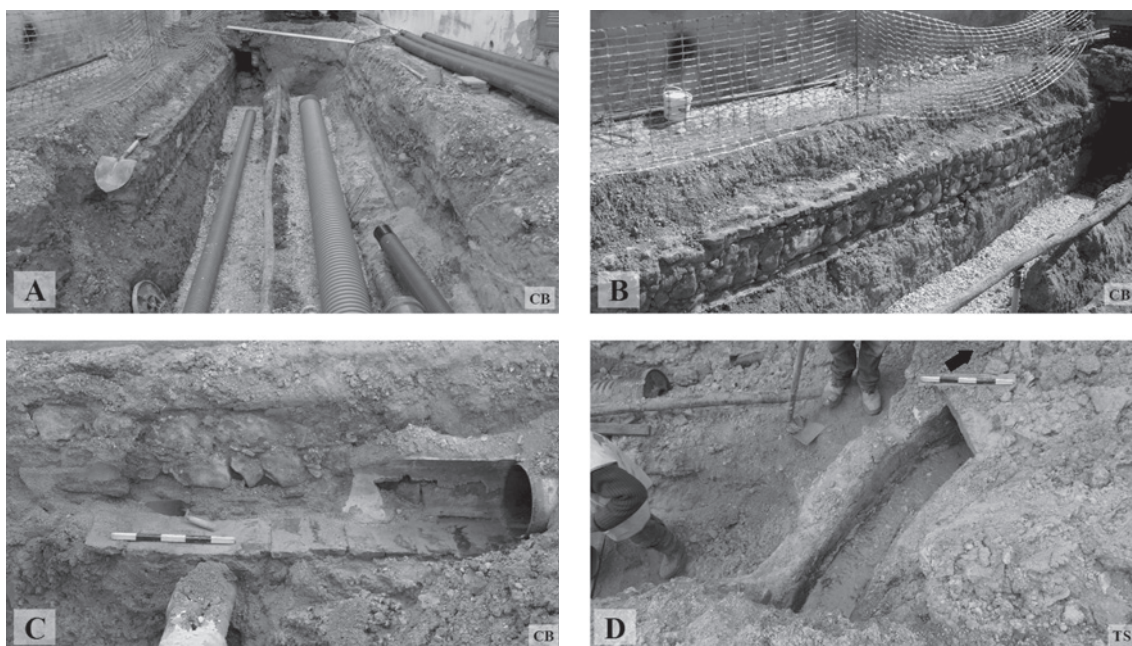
A – Vista geral dos trabalhos na Rua Braamcamp Freire; B – Vista geral da parede Este da conduta de saneamento que foi preservada *in situ*; C – Pormenor da conduta, vendo-se o pavimento cerâmico e o tubo de PVC existente no interior de uma parte da estrutura; D – Conduta no Largo Pedro António Monteiro. Fotos: C. Boavida e T. Silva.
